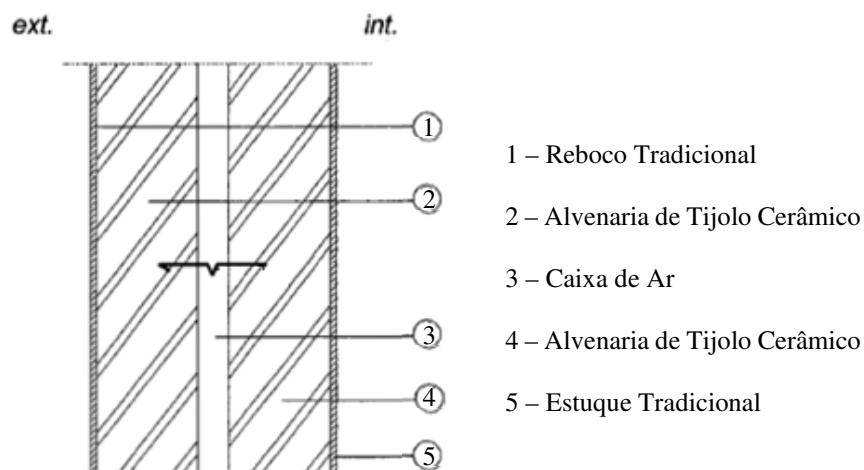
Pormenor construtivo da parede exterior geral, adaptado de [34]
